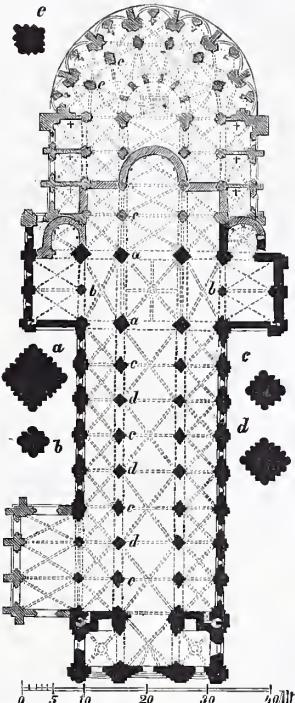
Dom zu Roskilde (Grundriss).
